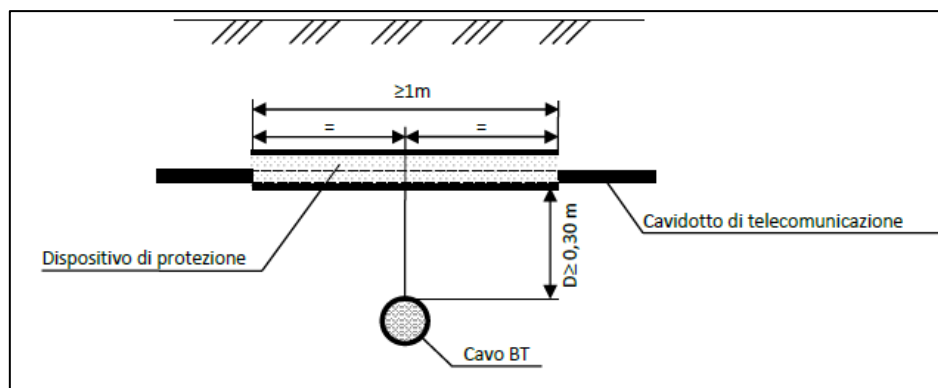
Tipologico di installazione con attraversamenti (art.6.1.1. norme CEI 11-17)
